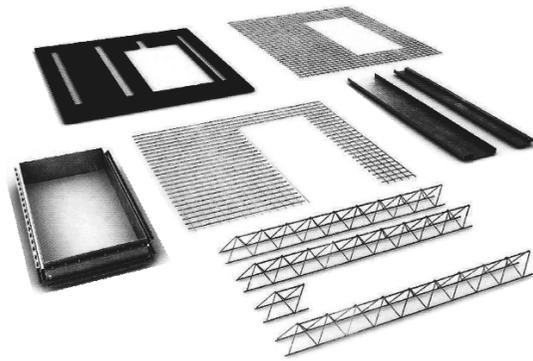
revestimiento prefabricado en concreto (Ejea Jurado José, n.d.)
